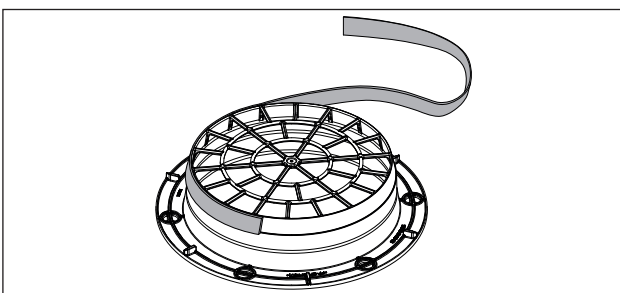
Position des Dichtungsbands für Montage mit Rundrohr
